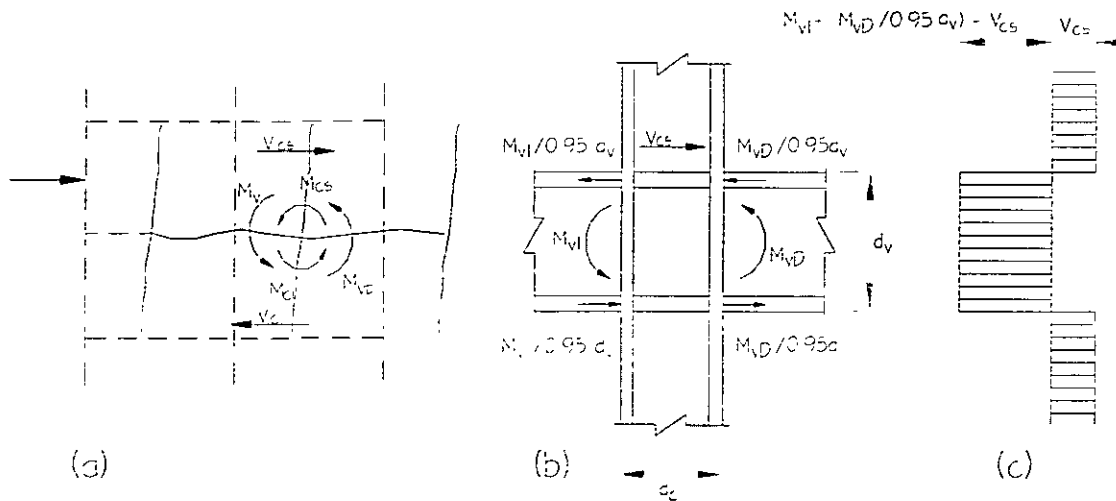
Junta de un marco rígido en el que obran cargas Verticales y horizontales
